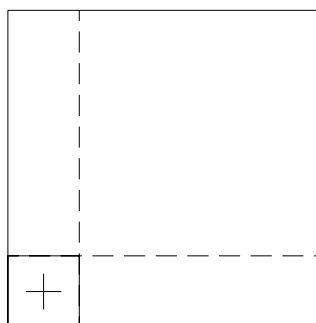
Planta de la zapata cuadrada con las dos vigas laterales
